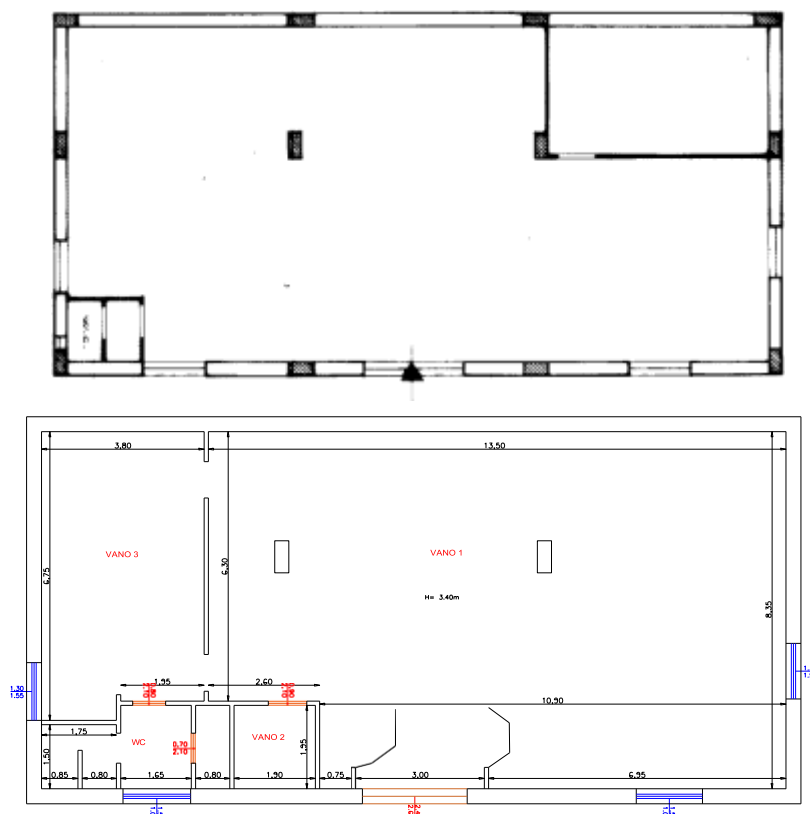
Raffronto planimetrie catastali (sopra) e planimetrie da rilievo (sotto) – PART 366 - SUB 2 – BENE I
